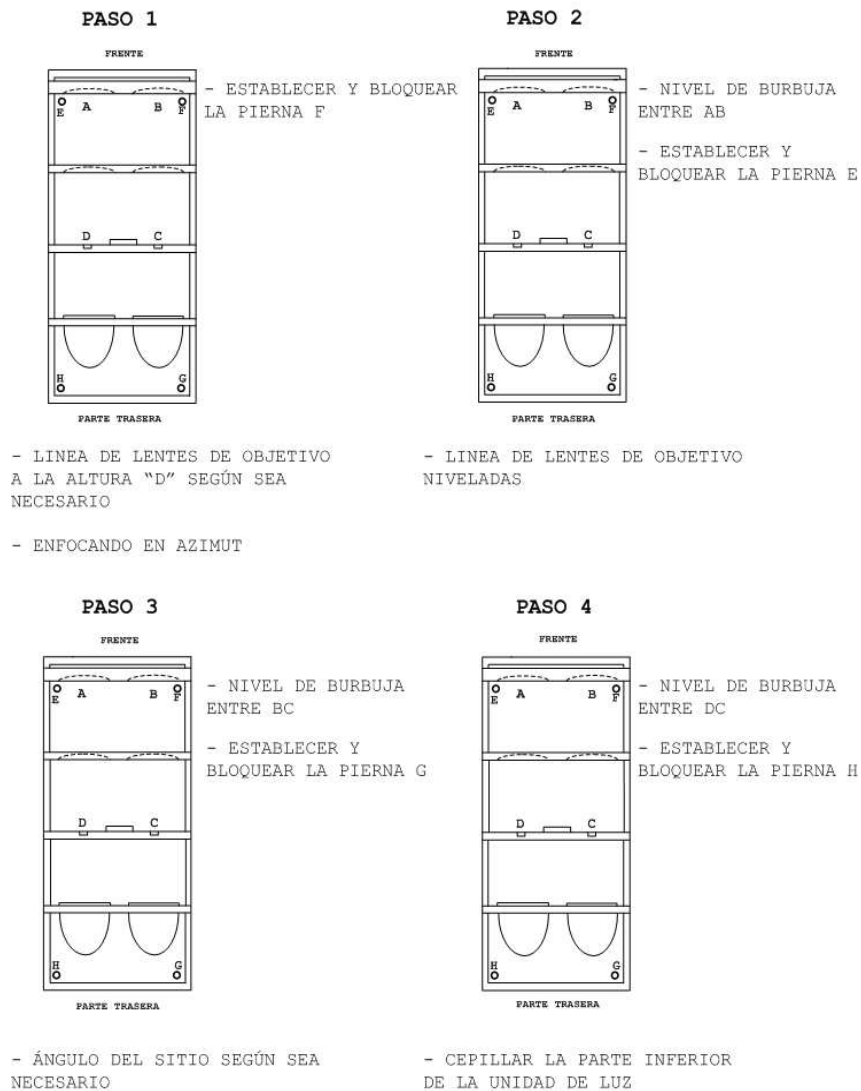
Montaje piernas de anclaje y unidad PAPI
